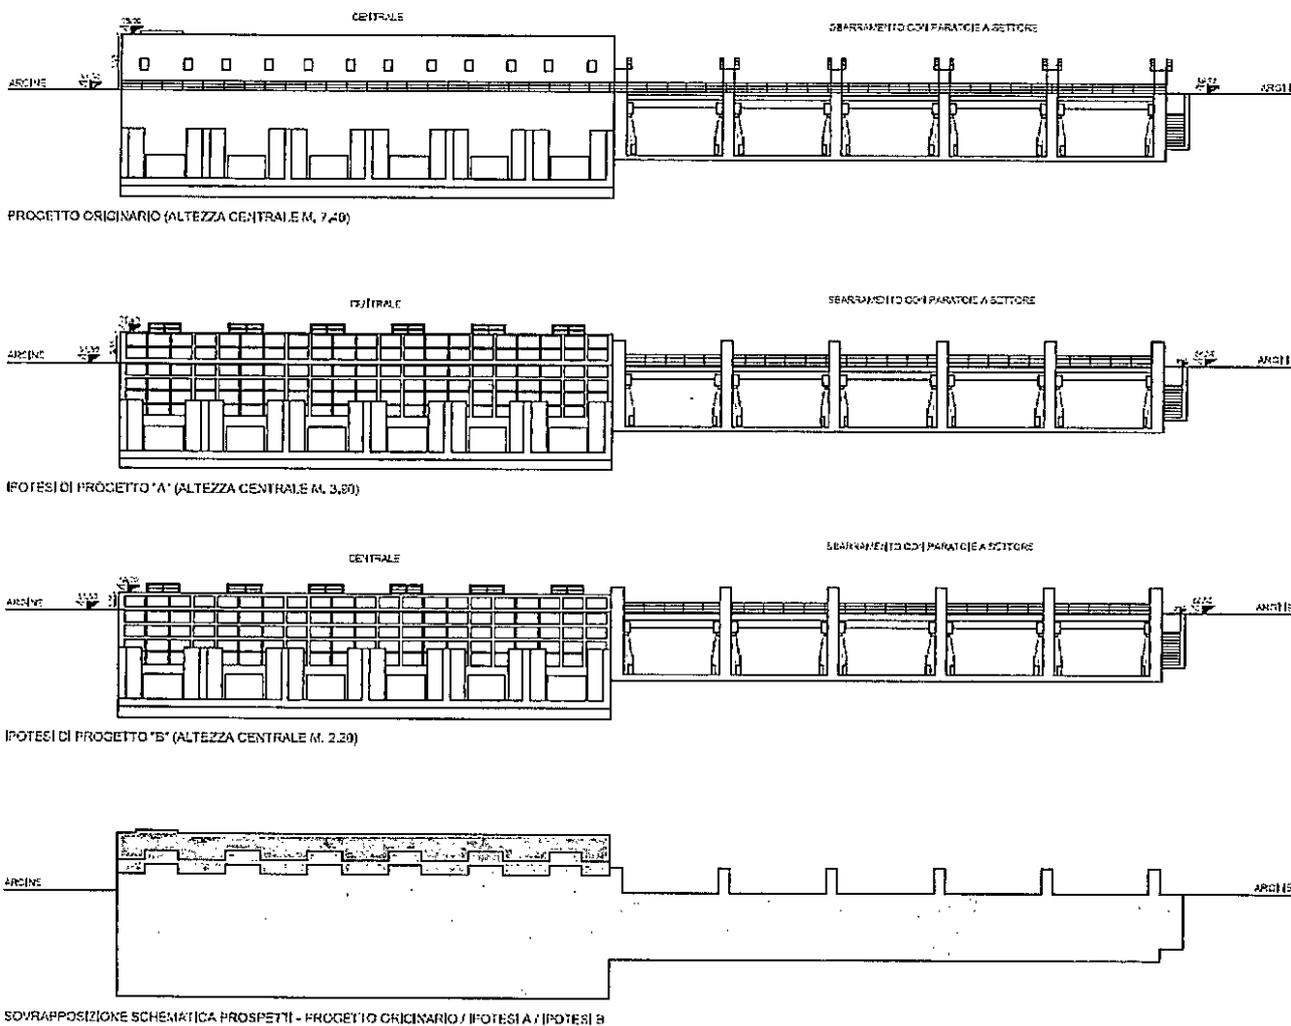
Prospetti della centrale idroelettrica nelle diverse ipotesi di progetto e loro sovrapposizione schematica
